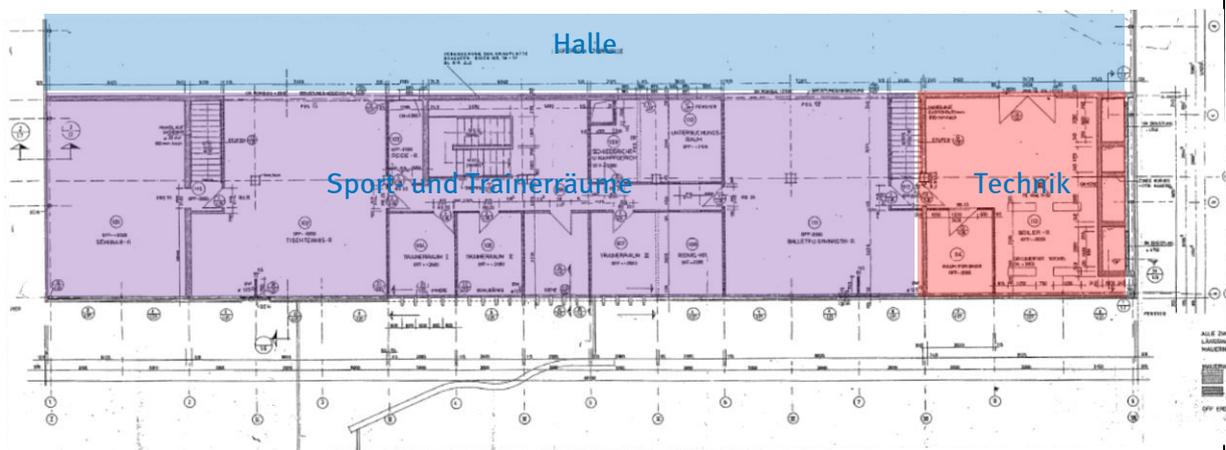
Grundriss TH 19 - Typ GT 75 L (Quelle: ZGM)
